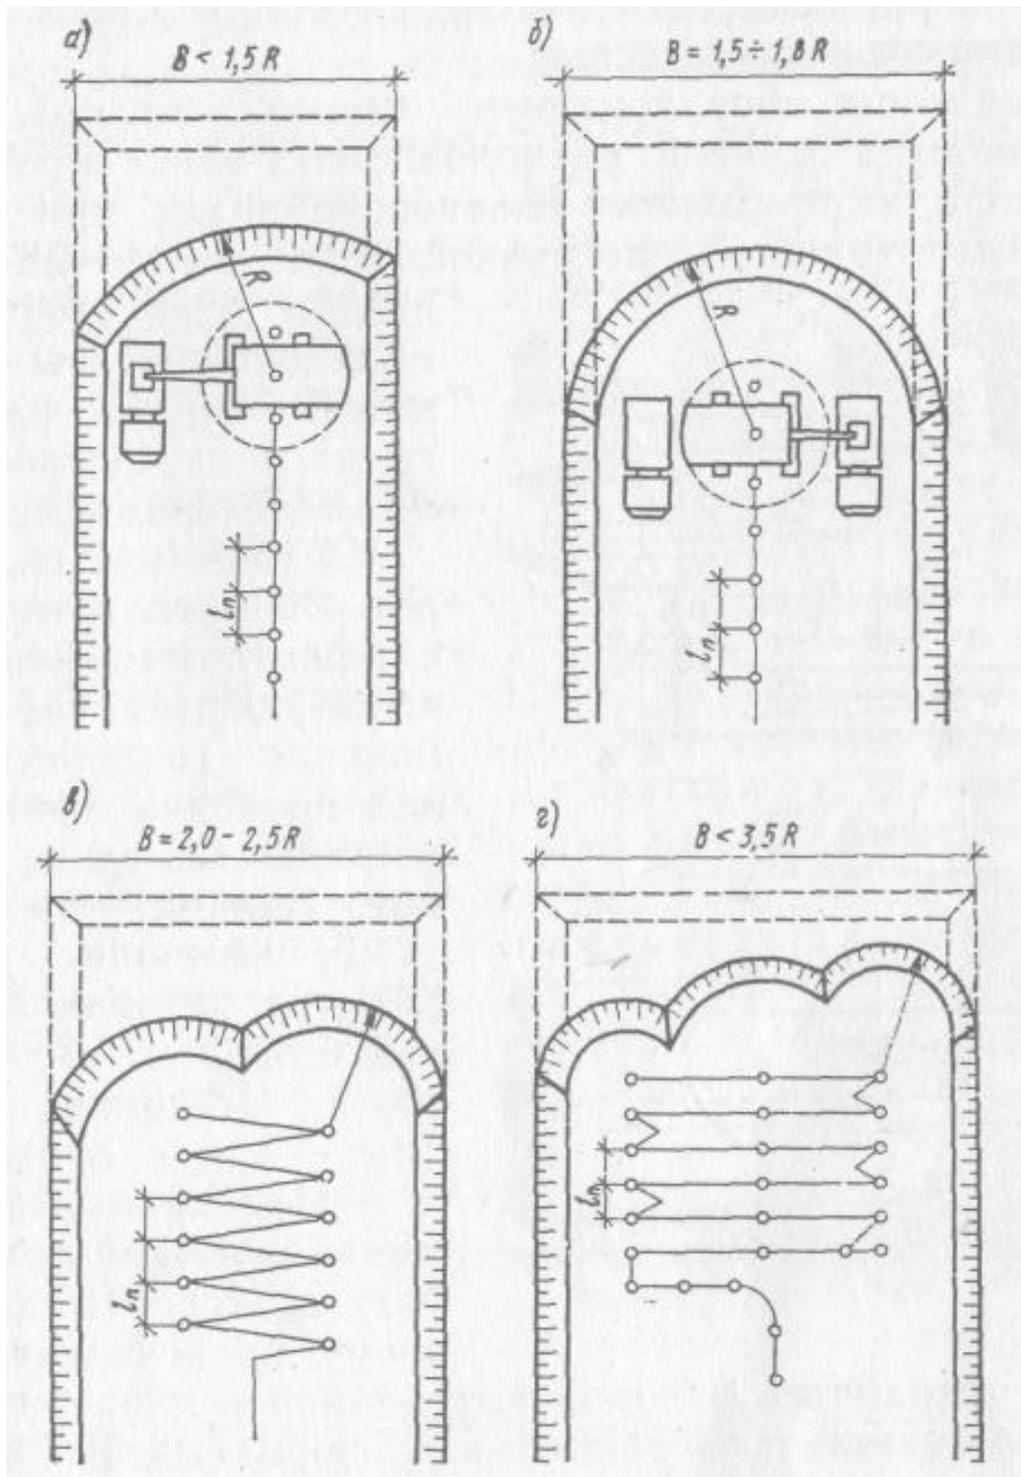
Разработка грунта экскаватором прямой лопаты:
